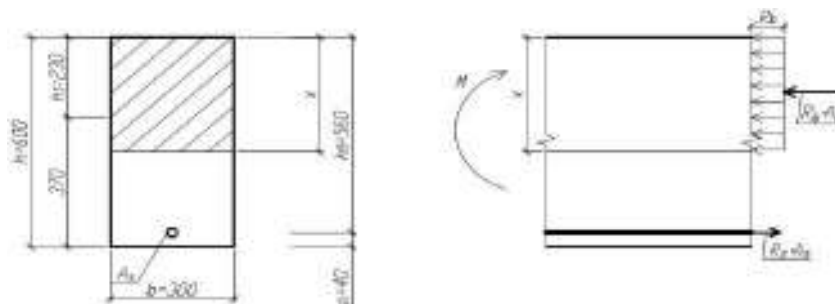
Поперечное прямоугольное сечение изгибаемого железобетонного элемента
